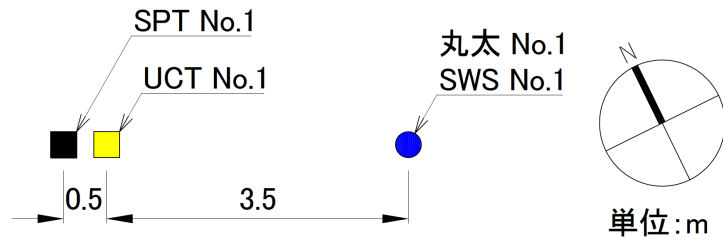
配置図と地盤調査位置 (TS 地点 : 東京都世田谷区)
